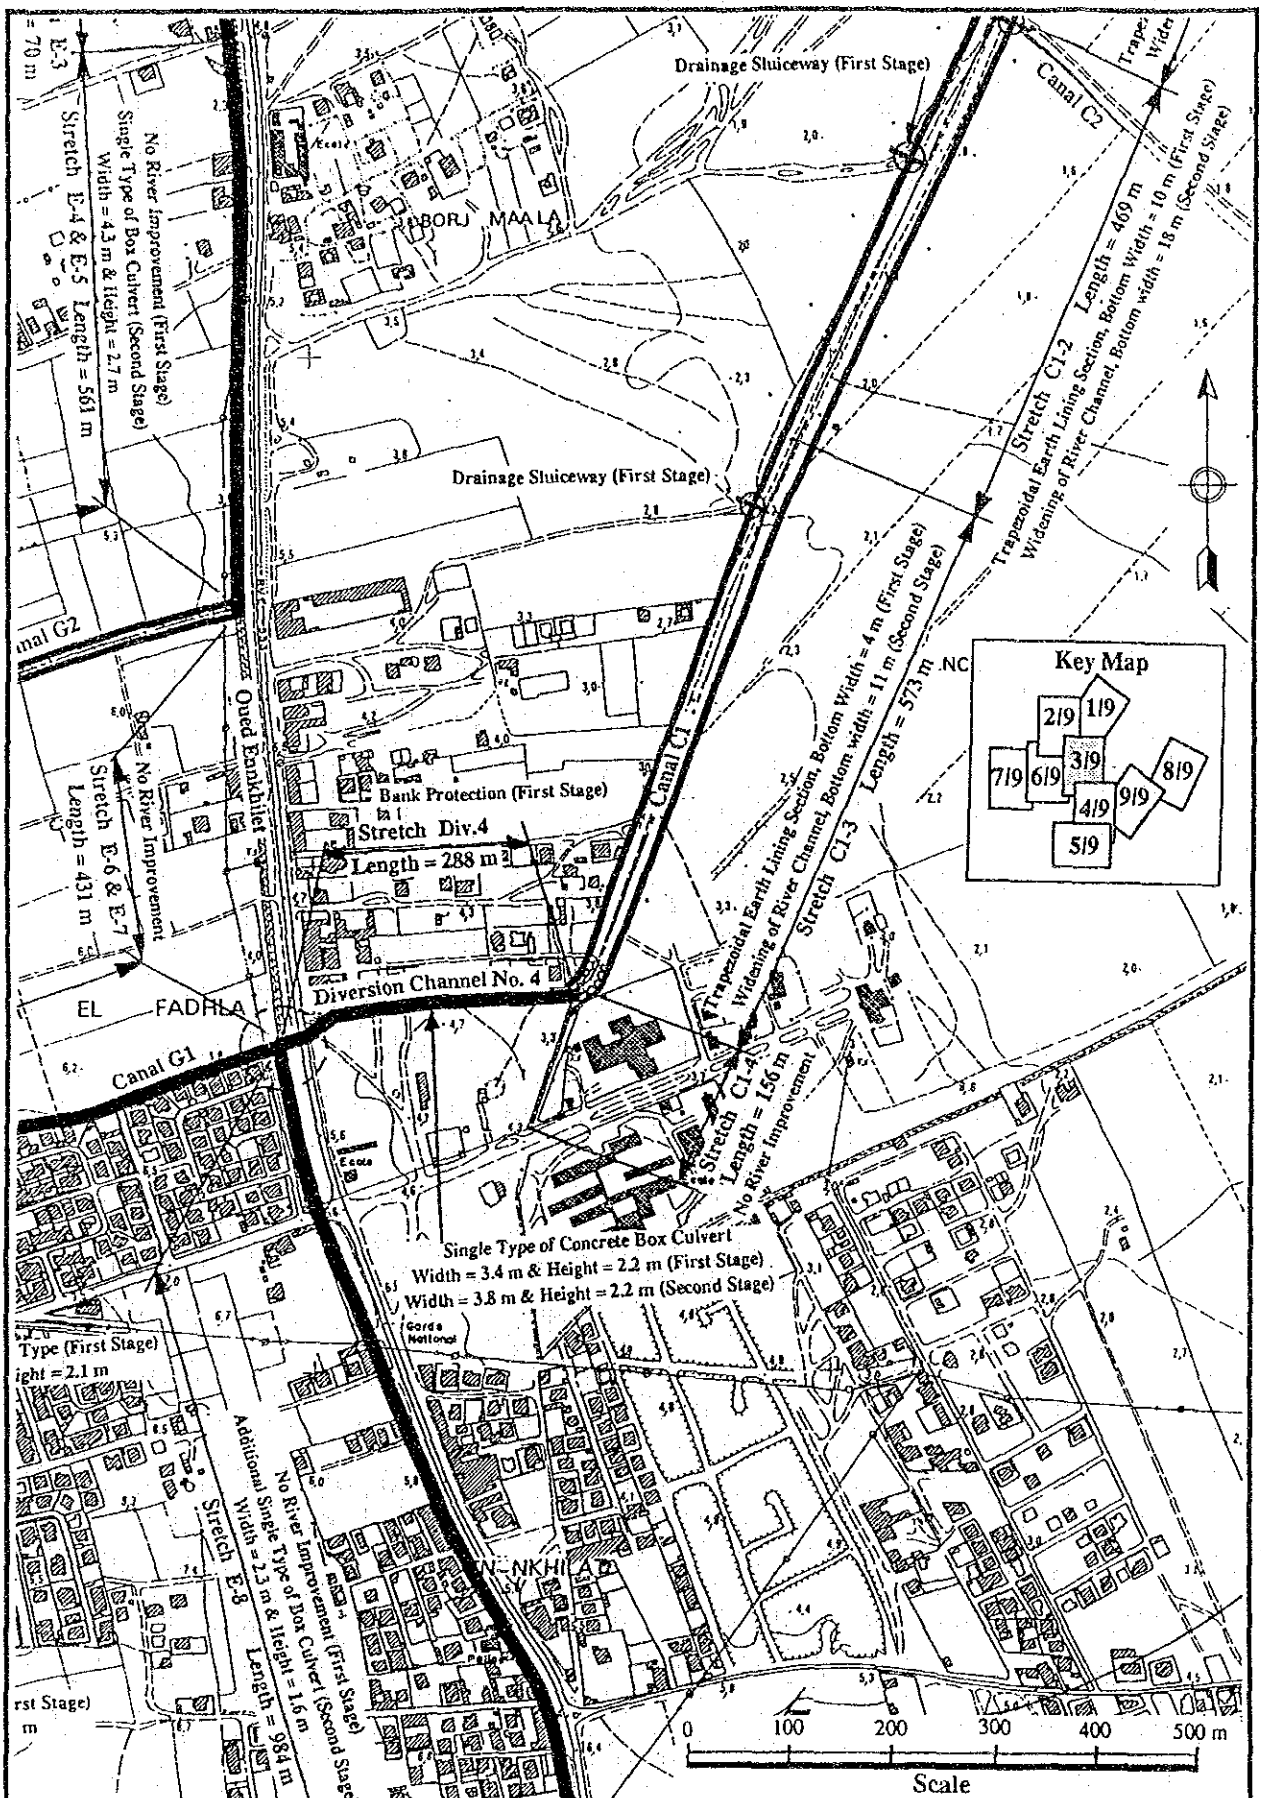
Tracé en plan de la variante d'aménagement de l'Oued Ennkhiilet (3/9)
